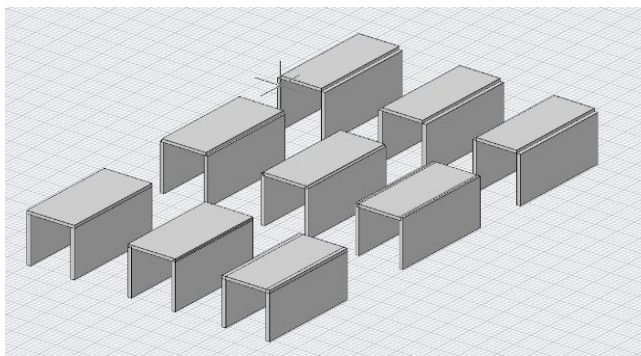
3D-элементы соединения плит перекрытий и стен в paпoCAD BIM Конструкции
